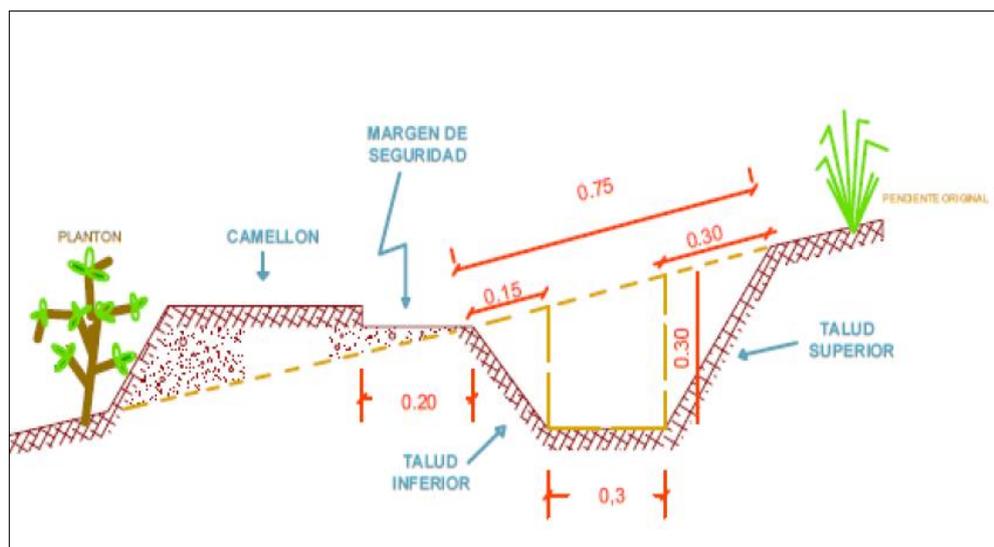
Corte transversal de las zanjas de infiltración. Fuente de elaboración propia.
